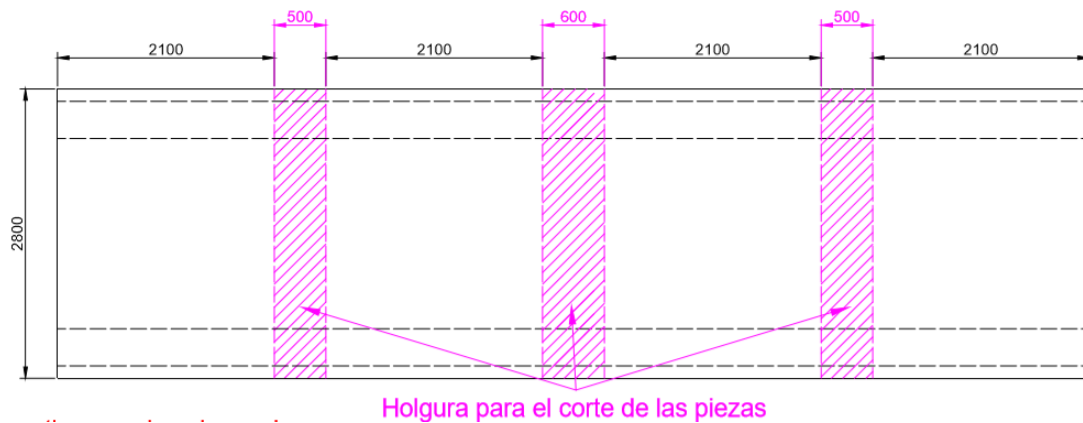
Corte de la sección longitudinal primera propuesta sin daños en los extremos
